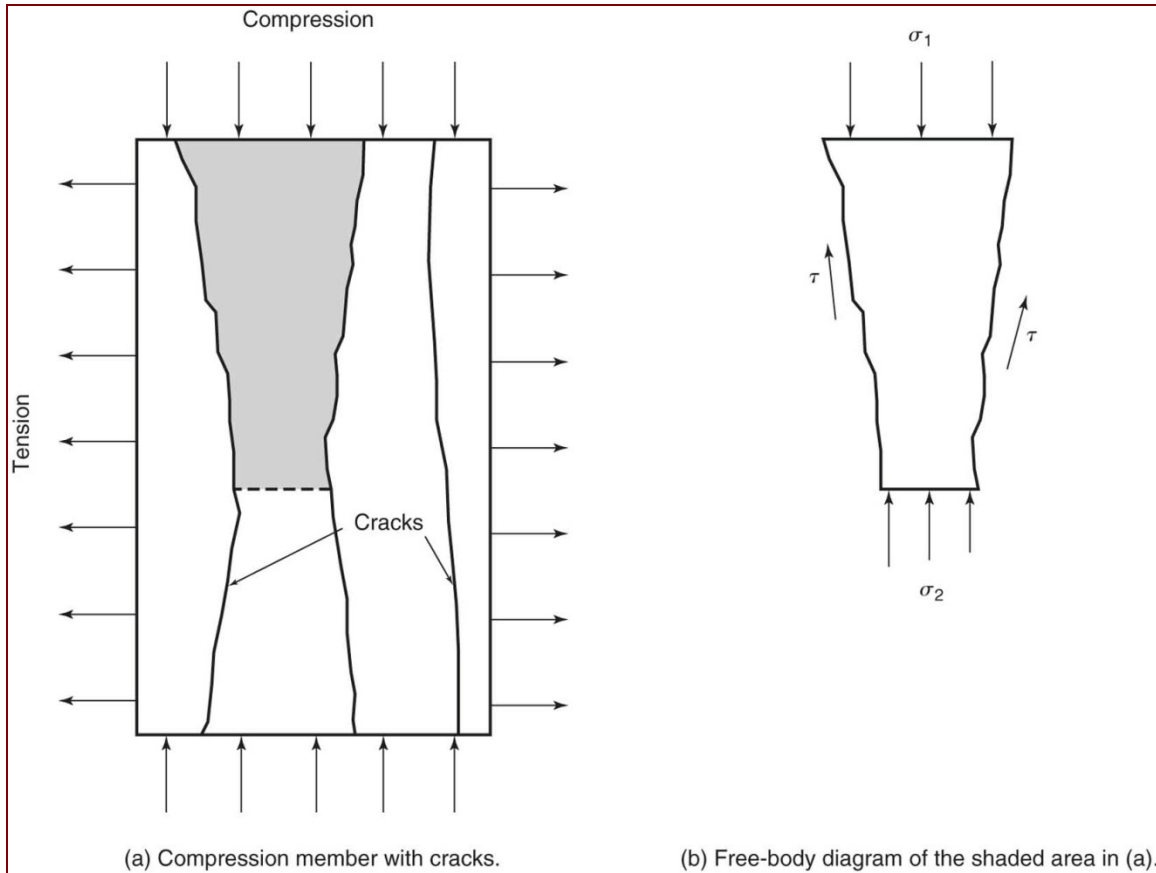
Esfuerzos en un elemento de concreto agrietado.
